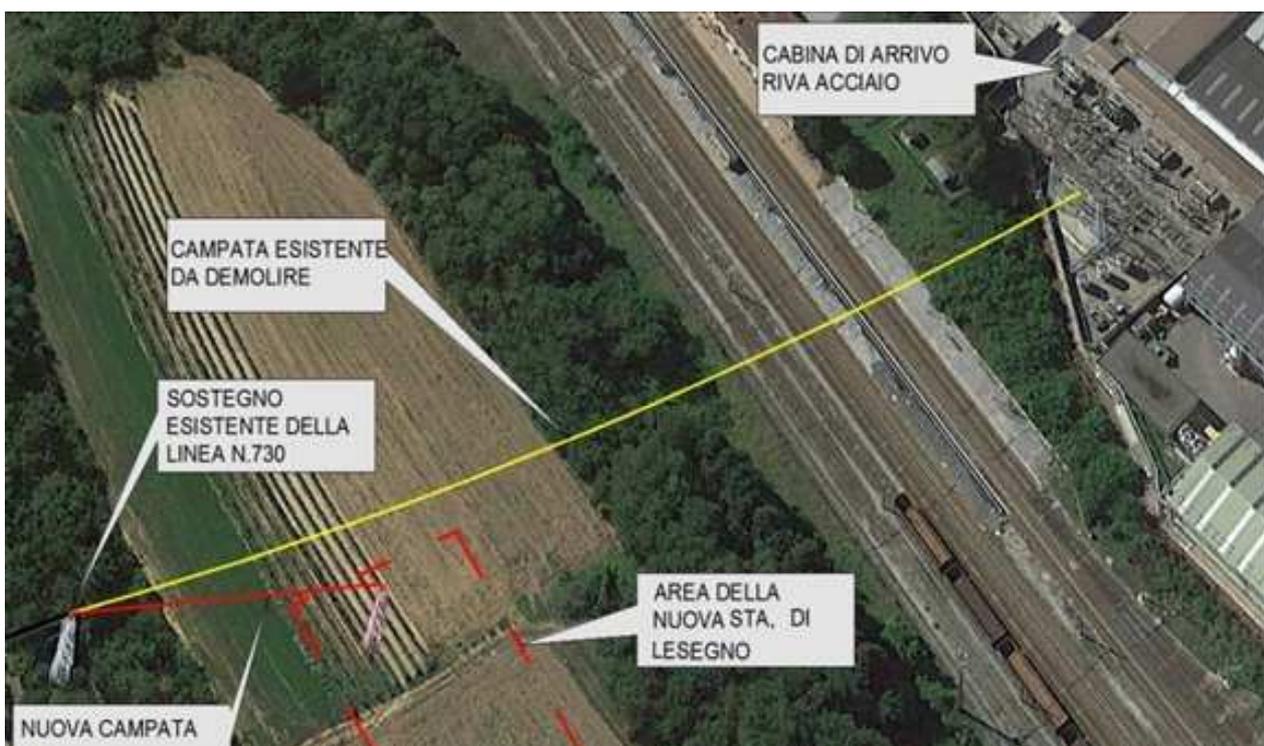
Ortofoto con indicazione della campata della linea esistente Enel da demolire (in giallo) e collegare alla nuova stazione elettrica di Lesegno (in rosso)
